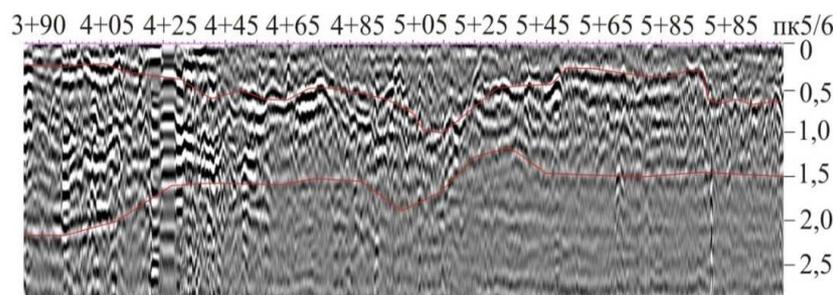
Георадарное обследование насыпи на ПК 4+70 - ПК 5+25
